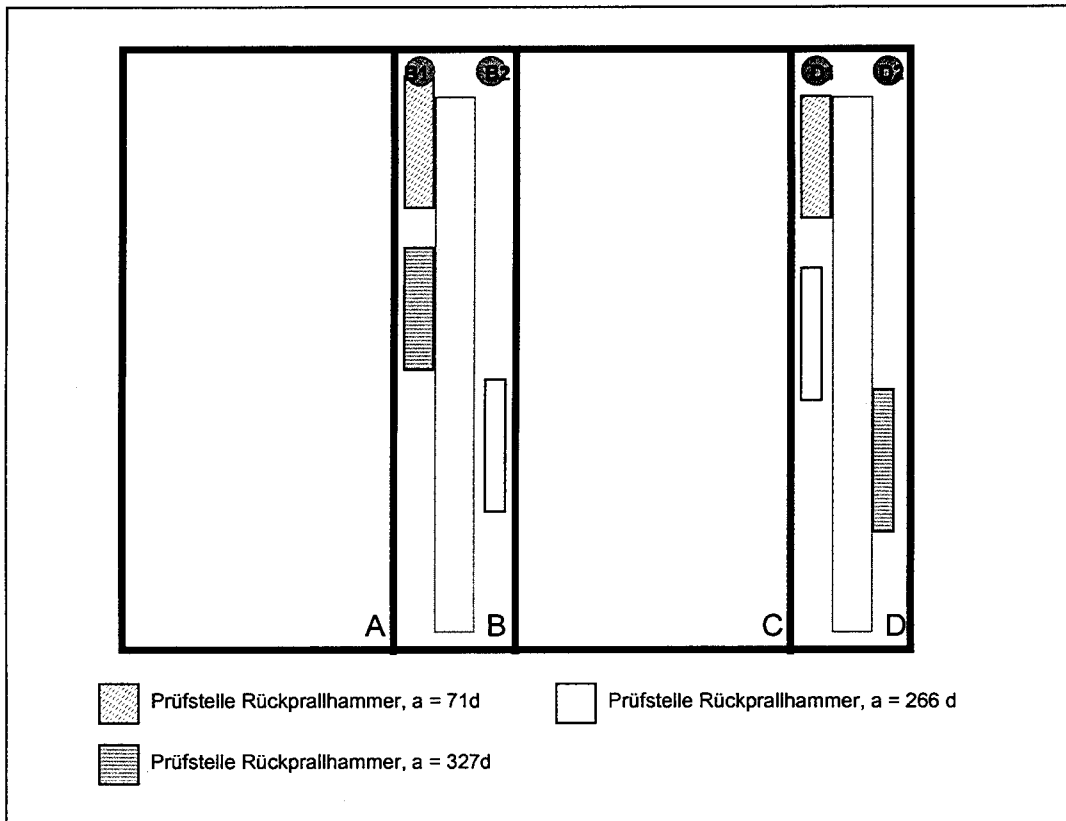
Lage der Prüfflächen am Betonkörper 12
